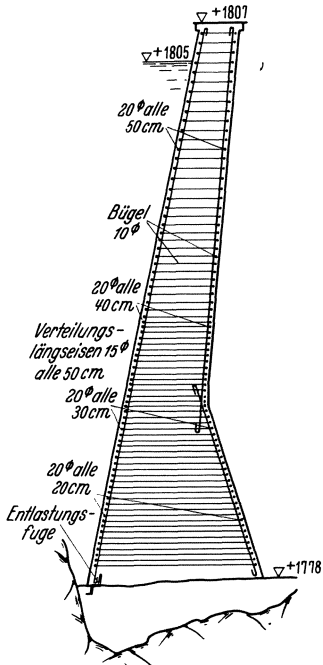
Eisenbetonbogenmauer Malciaussia. Querschnitt und Bewehrung.
